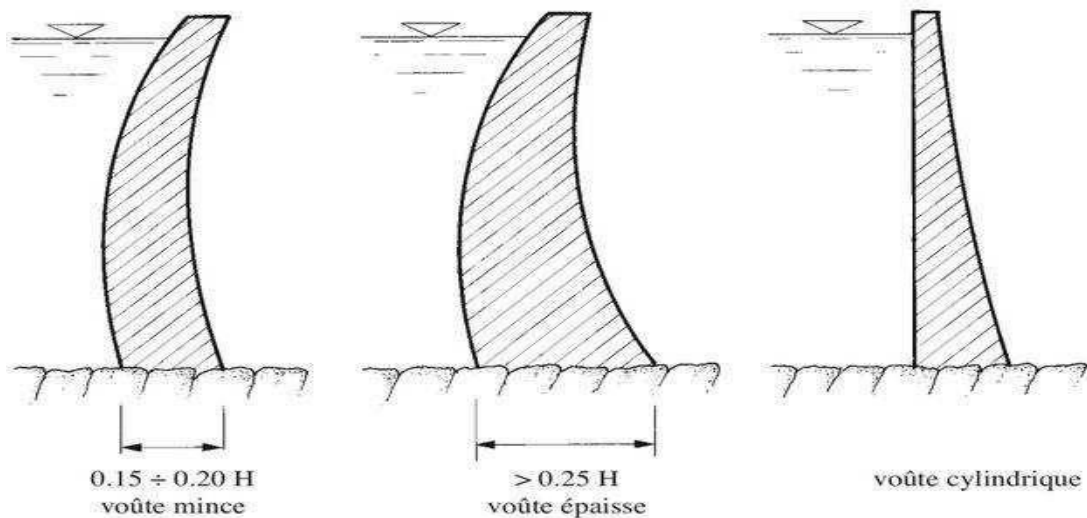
Coupe transversale d'un barrage en voûte (Schliess et Pougatch, 2011)
